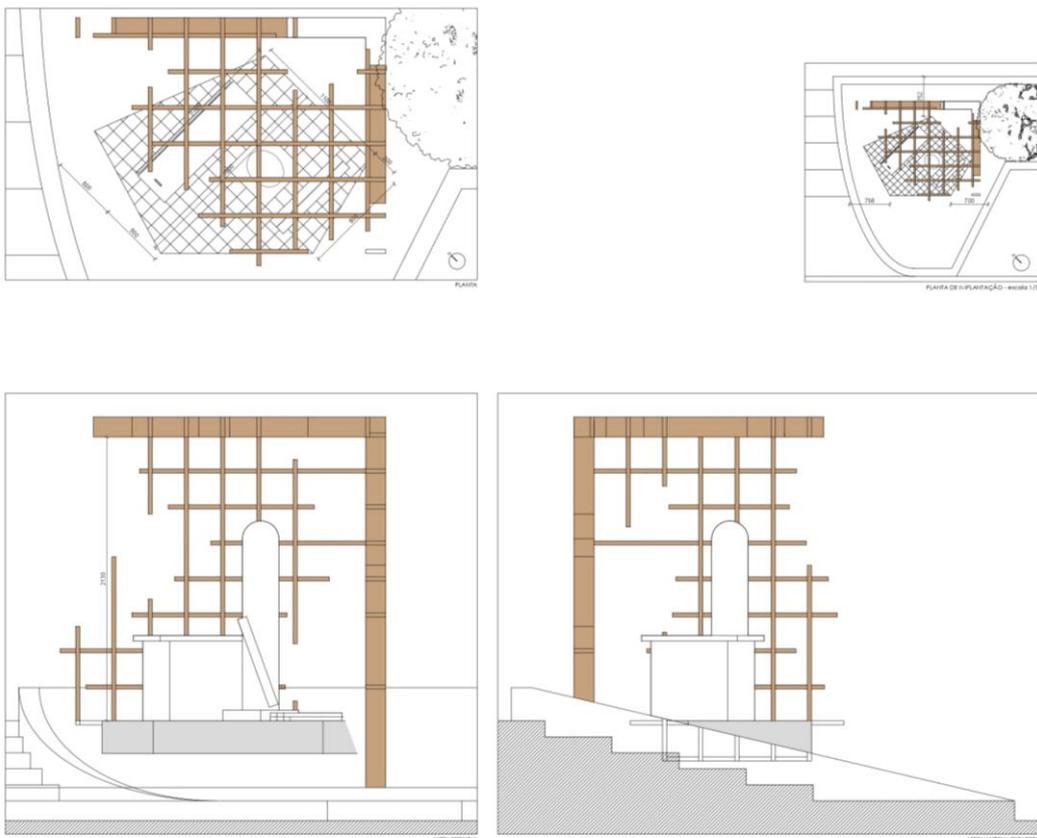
Desenho técnico. Fonte: Paula Sousa.
